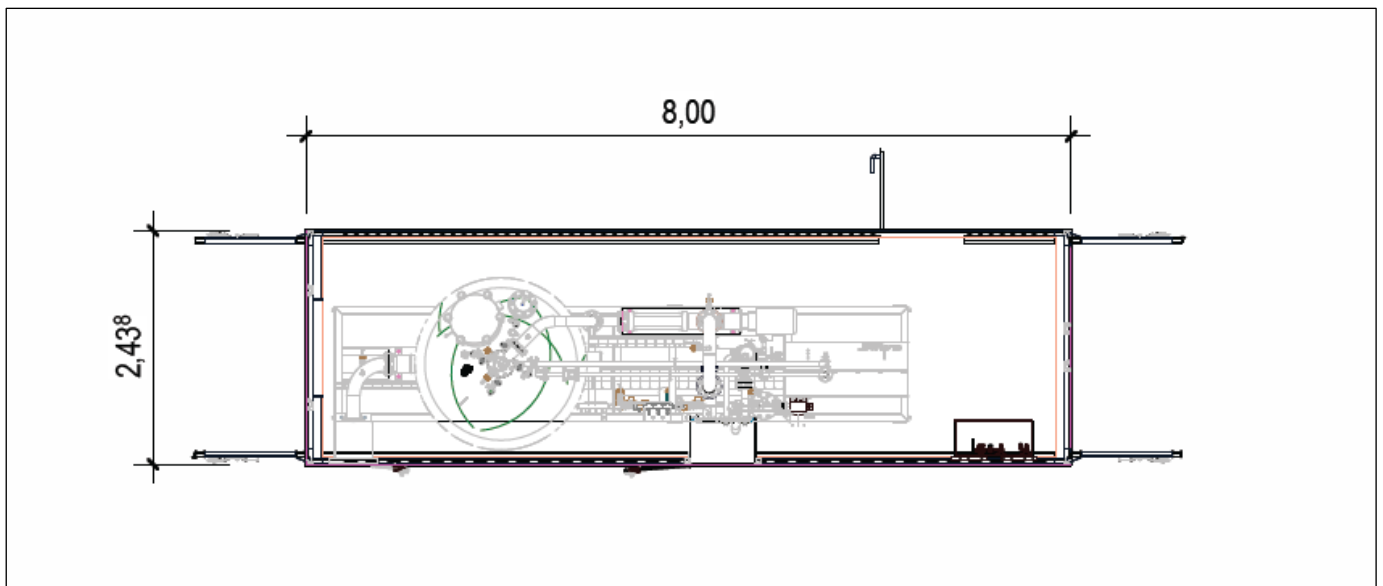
Grundriss Maschinencontainer (o. M.)
